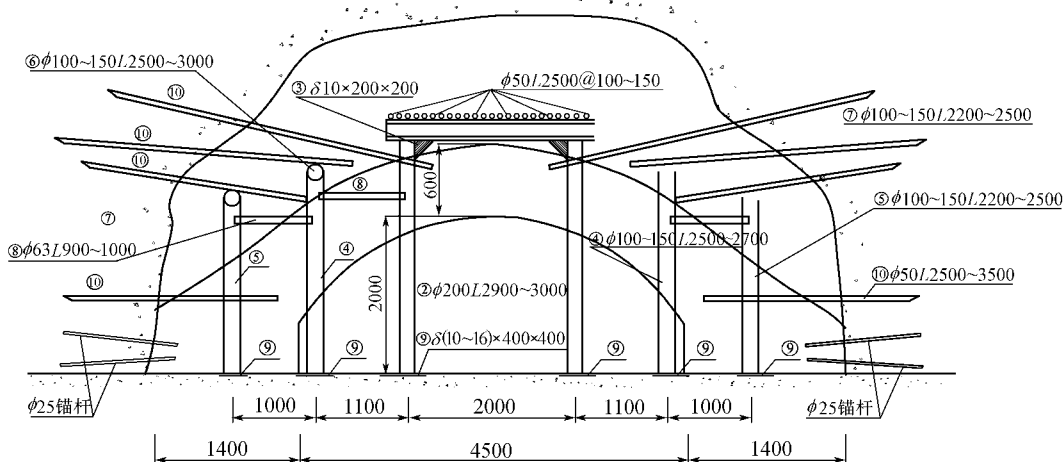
顶拱塌方处理支撑及混凝土浇筑横断面(单位:mm)
